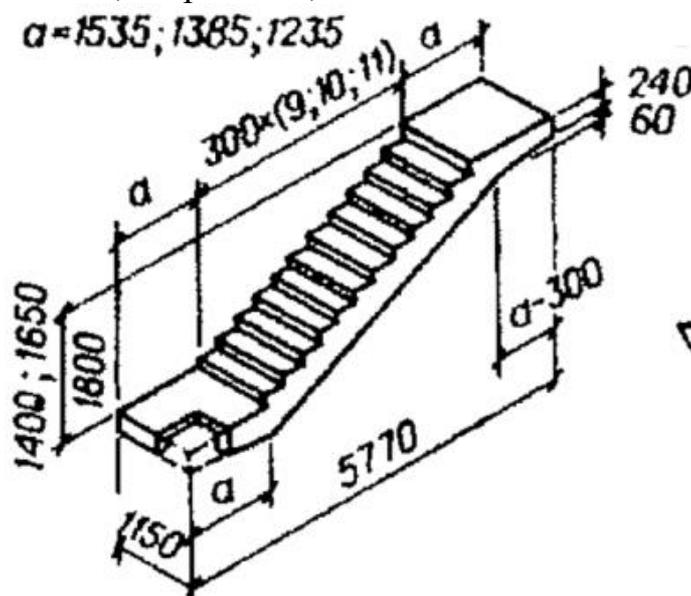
Сборные гнутые лестничные марш-площадки каркаса 1.020
